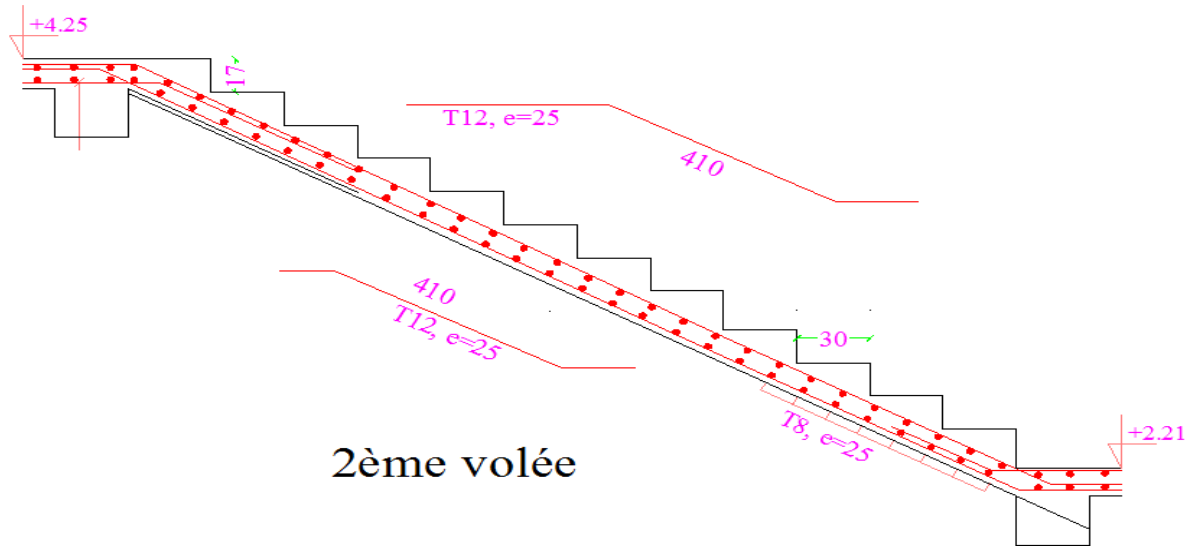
ferrailage de la 2<sup>ème</sup> volée
